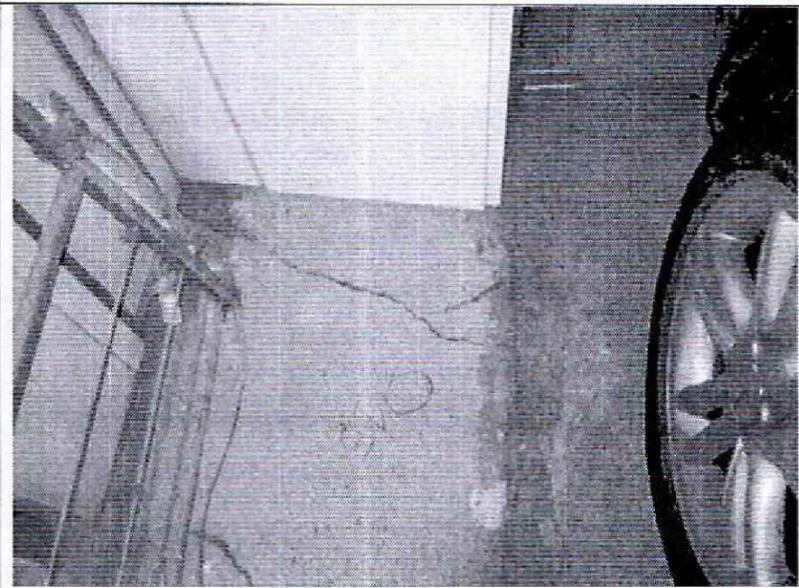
Grietas en varios sectores de la placa de piso.
